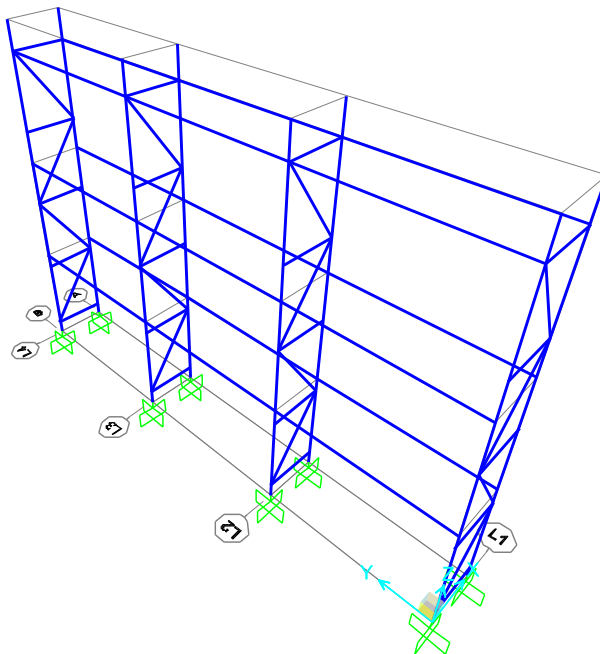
Vista 3D del modelo estructural para el rack selectivo
